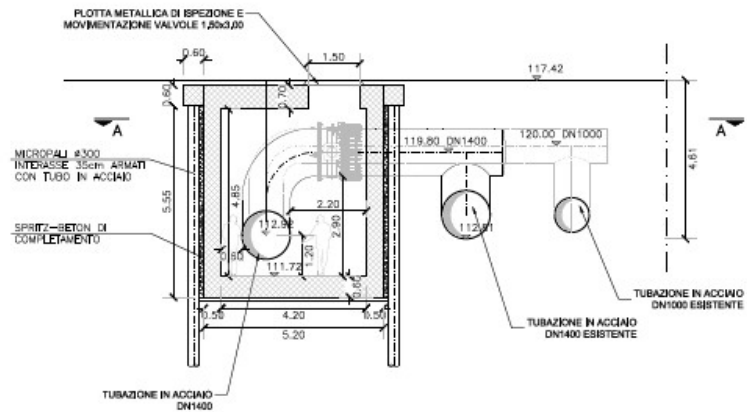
Pianta e sezione del Manufatto Pestalozzi
